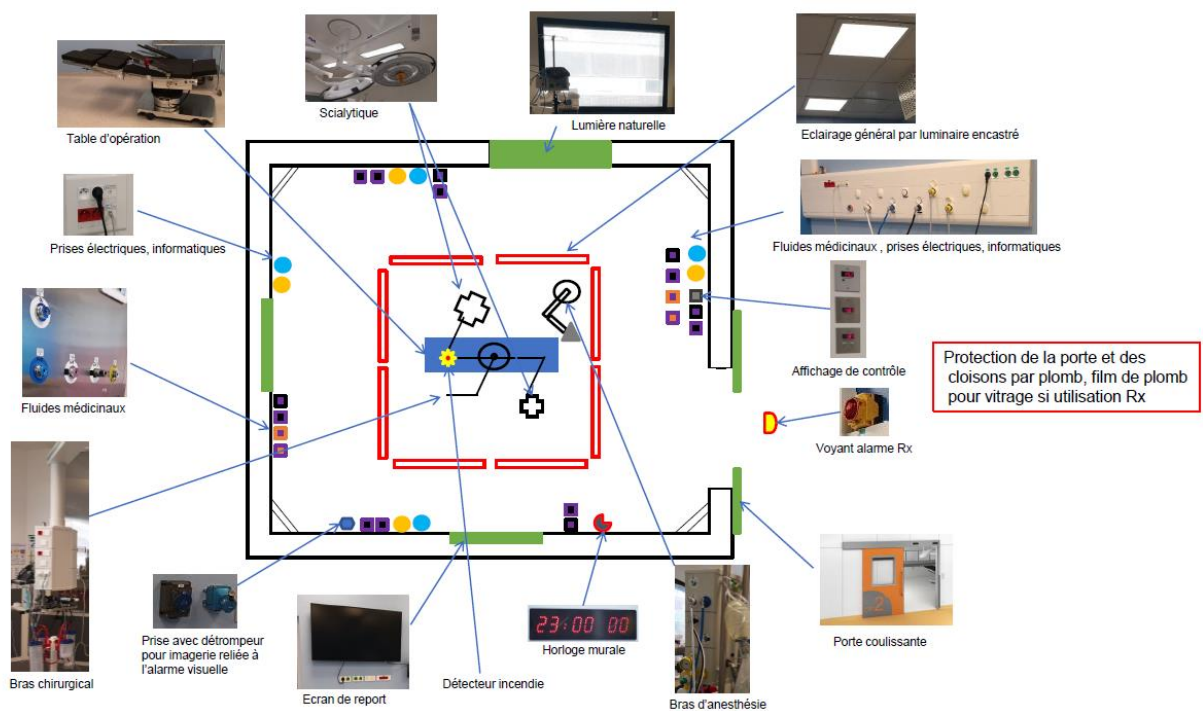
Proposition d'un plan d'aménagement d'une salle d'opération Source : auteur
